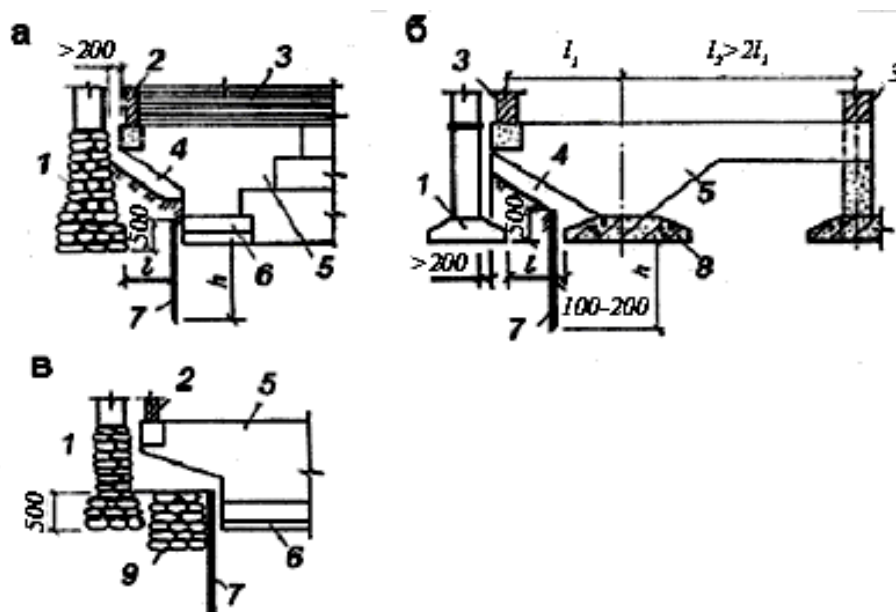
Консольное примыкание к существующим фундаментам новых зданий:
